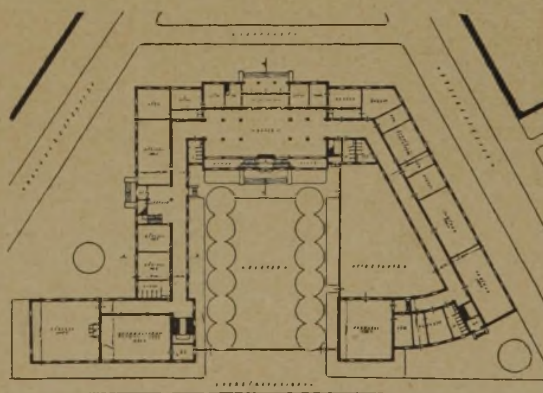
Grundriß vom Erdgeschoß. (1 : 1500.)
